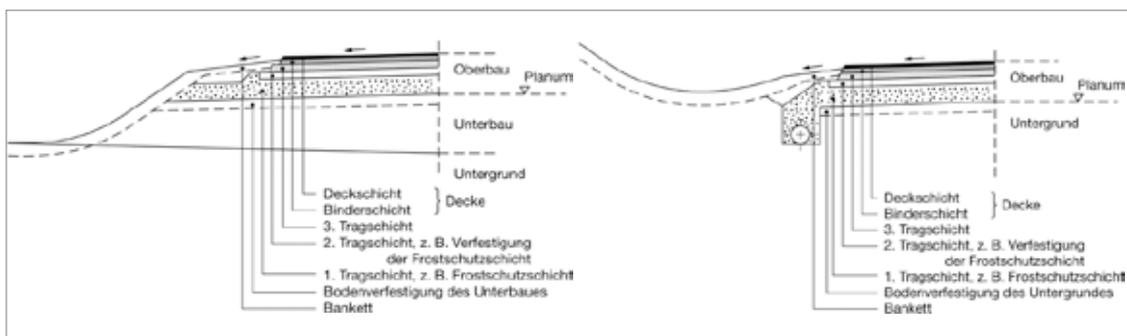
Beispielhafter Aufbau einer Befestigung mit Asphaltdecke – Damm/Einschnitt (Quelle: RiStWag)
